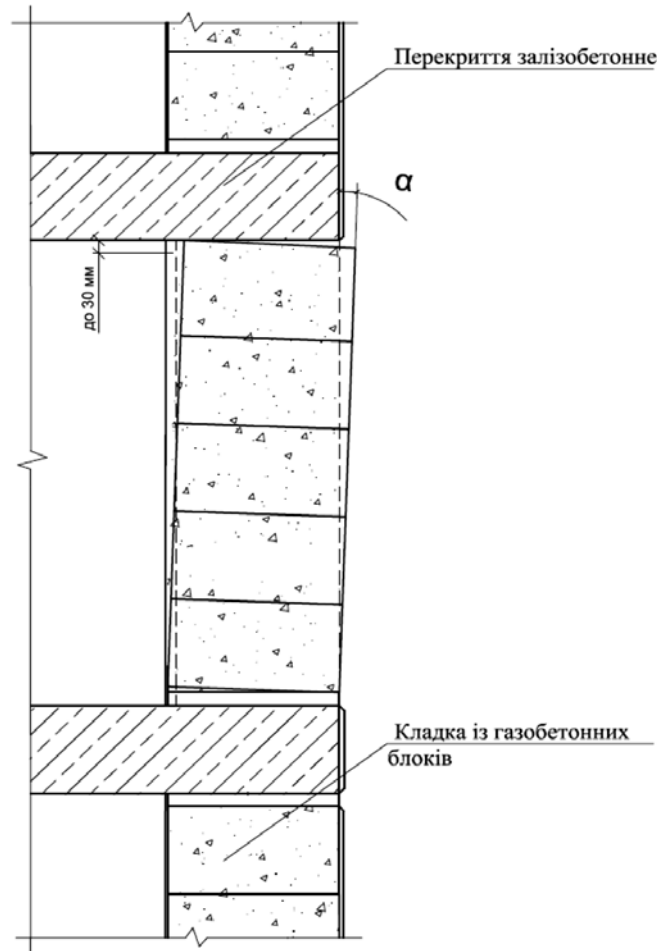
Схема можливого перекидання фрагмента стіни і його зацемлення верхнім перекриттям
